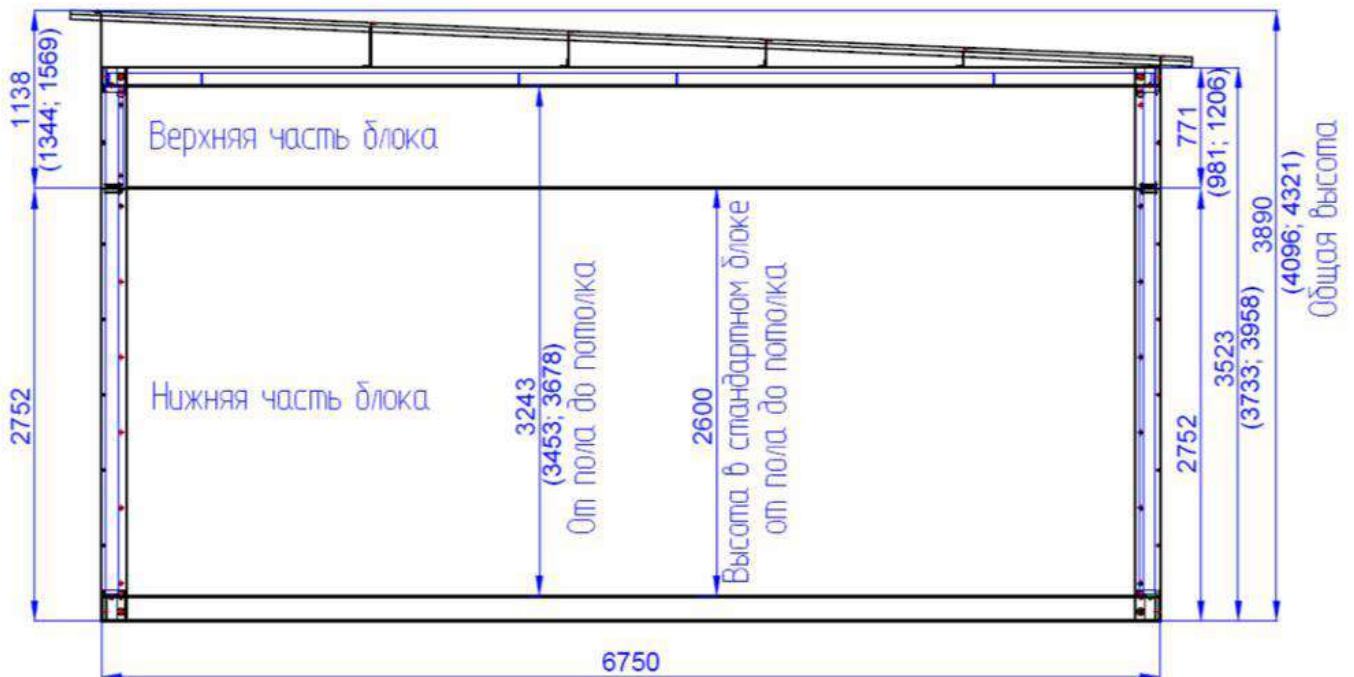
Габаритные размеры модуля с увеличенной высотой
